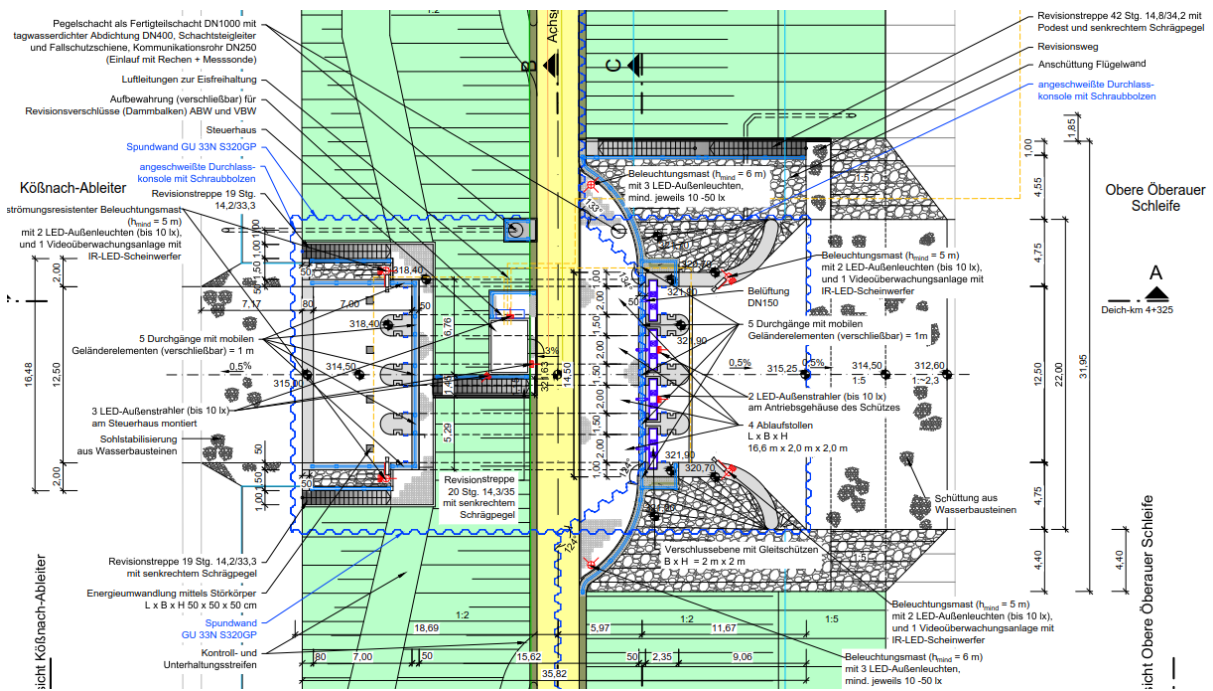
Auslaufbauwerk, Draufsicht (aus Plan 04-02-05, Blatt 1/2)
